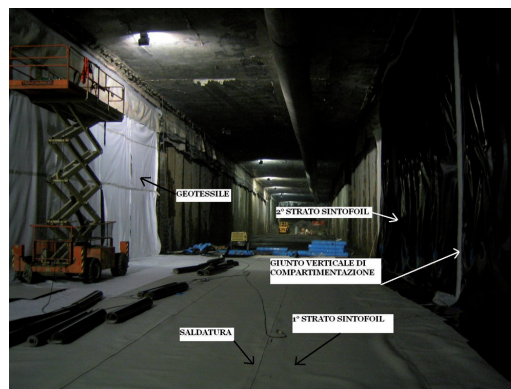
Attività di posa impermeabilizzazione in galleria. The positioning of the waterproofing in the tunnel. (Geofabric; 2nd layer of sintofoil; vertical compartmentalisation joint; 1st layer of sintofoil; welding).
